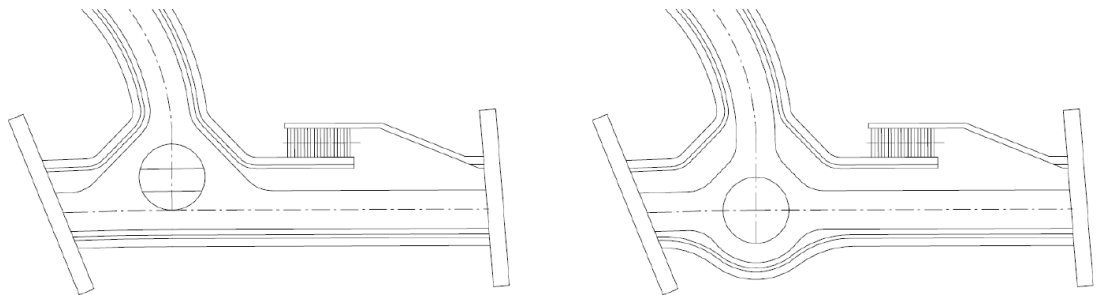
Aansluiting voor voetgangers met trap (links) of hellingbaan (rechts).
